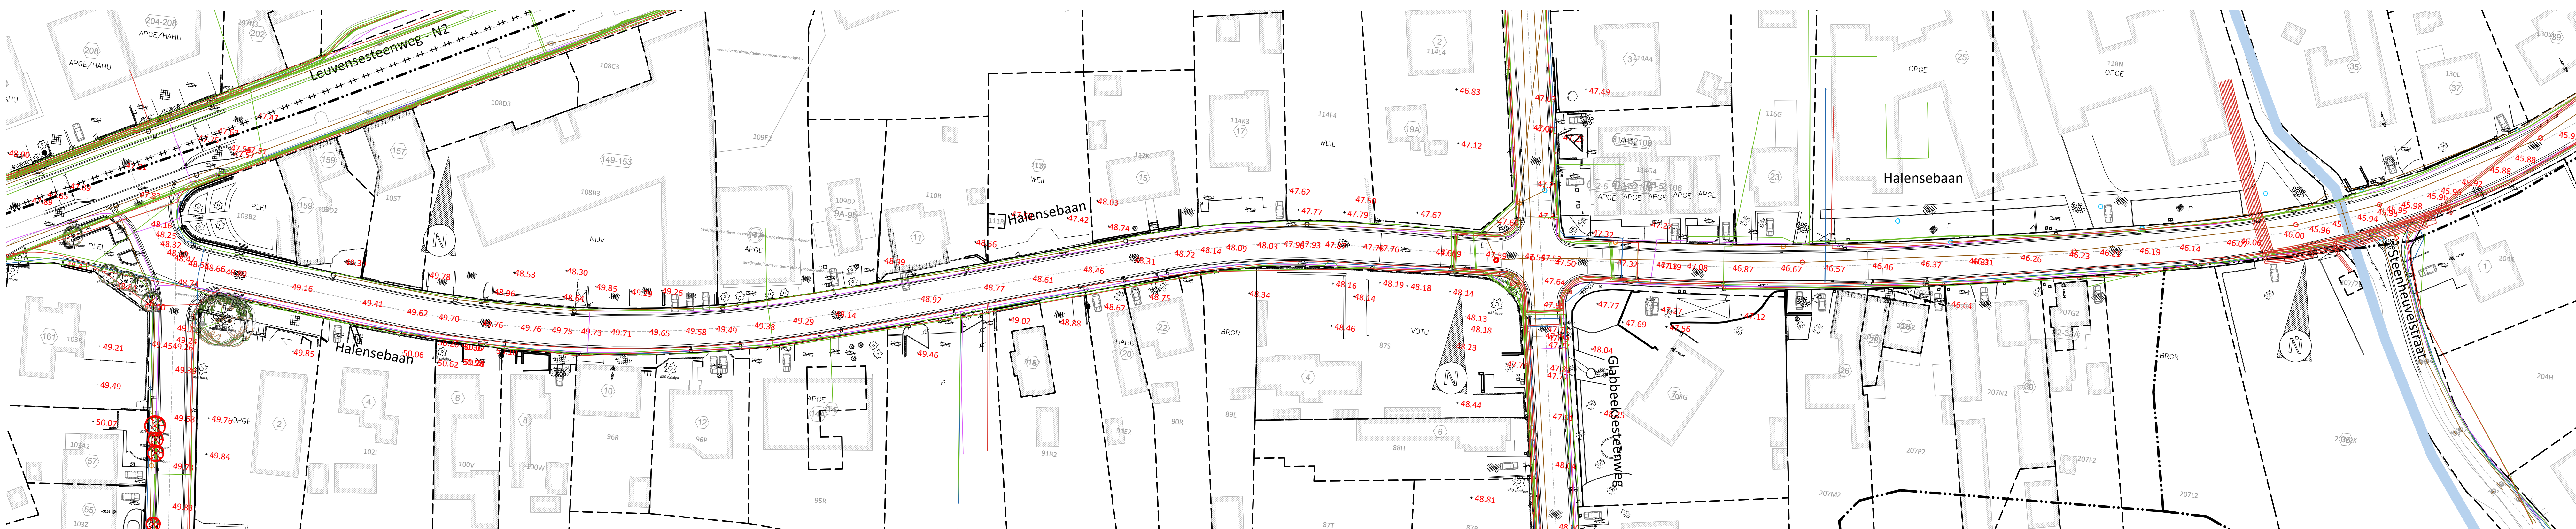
DETAIL UITVOERING LIJNVORMIGE ELEMENTEN
